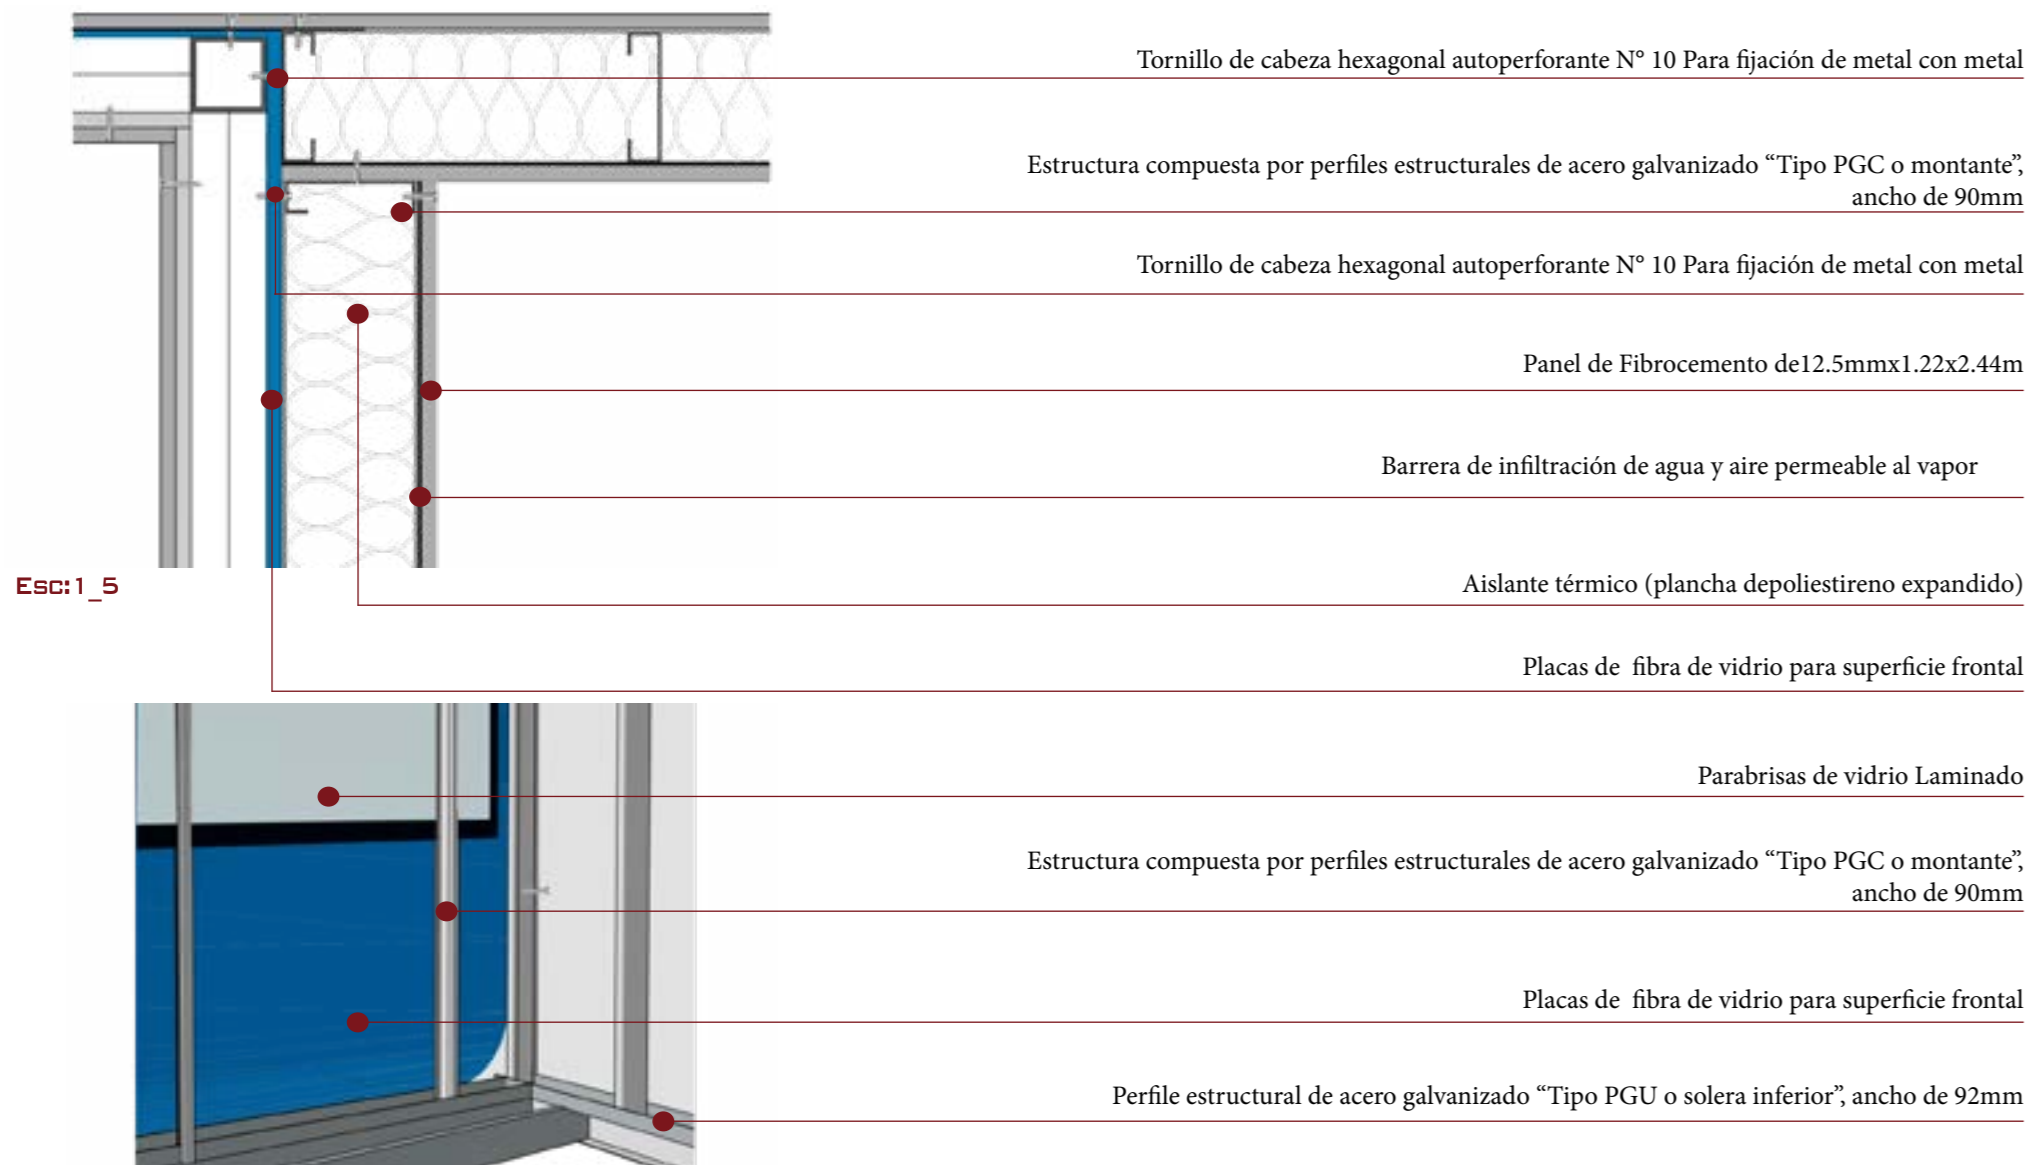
Imágen_Detalle Unión estructura de Bus con pared de Baño
